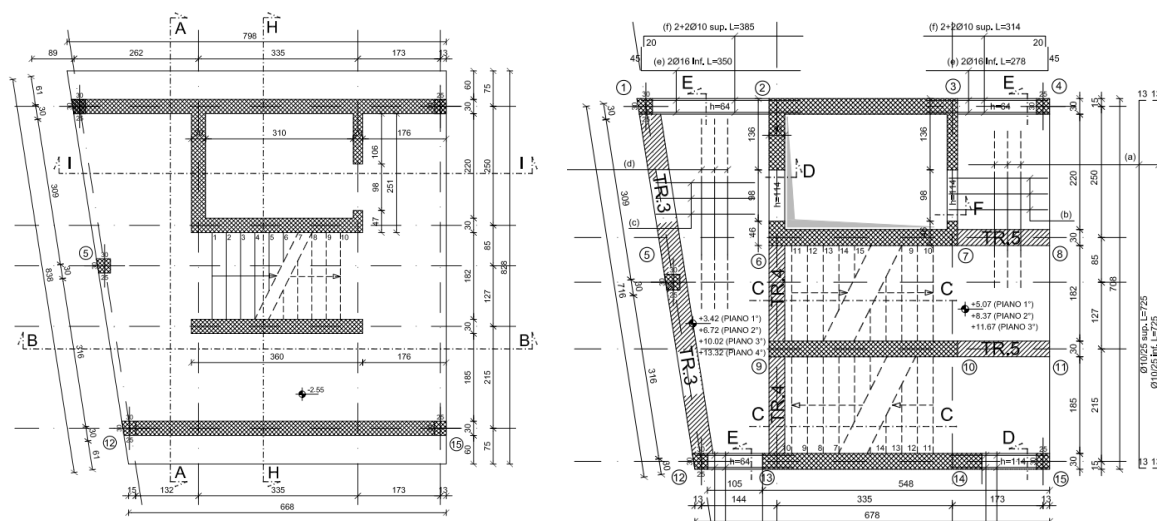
Pianta fondazioni (sinistra) e piano tipo (destra) corpo C
